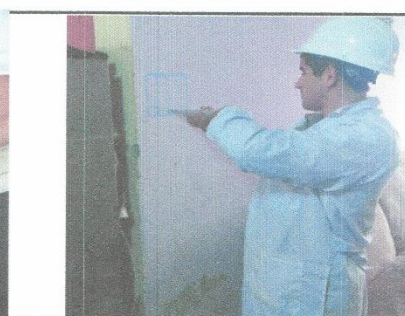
Realizando aplicación del esclerometro en la cara de la columna de la vivienda familiar.
